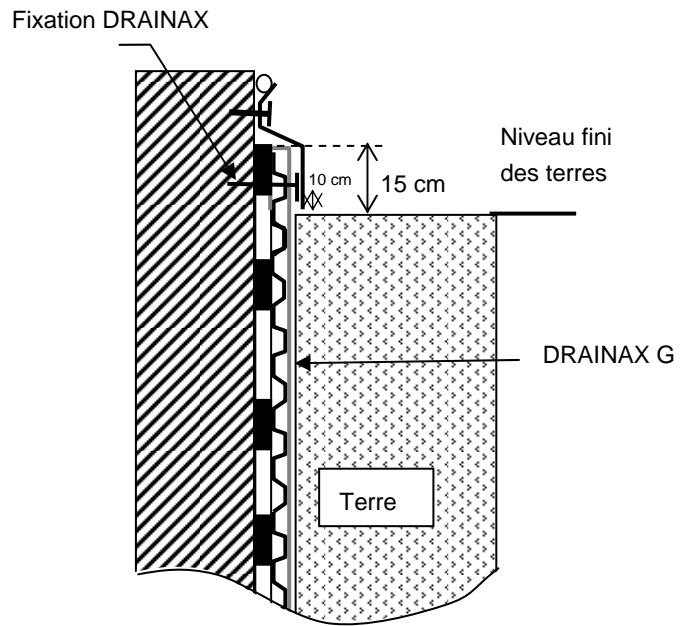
Arrêt supérieur du DRAINAX G sur étanchéité
